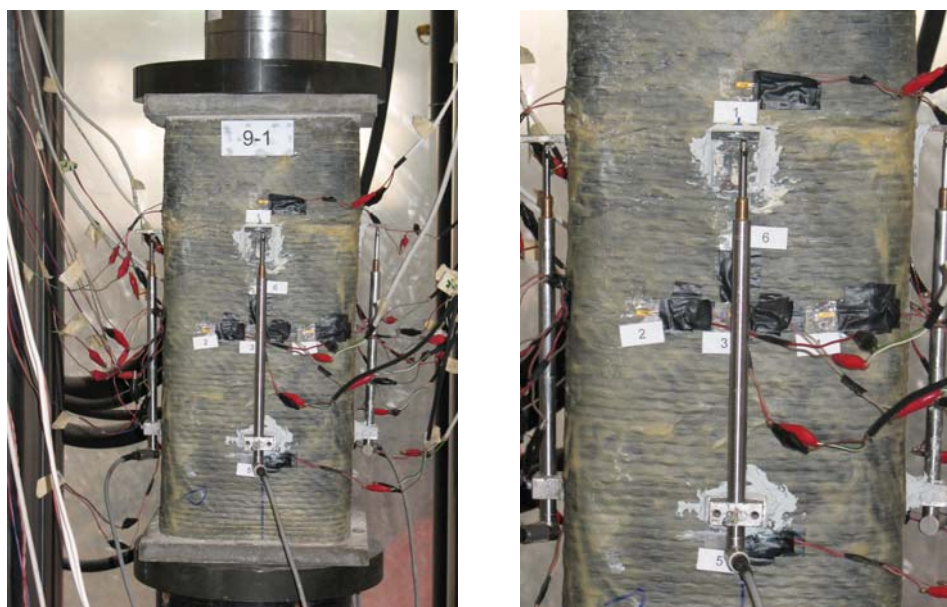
Distribuzione Strain-Gauges sulla generica faccia dei pilastri in muratura di tufo
